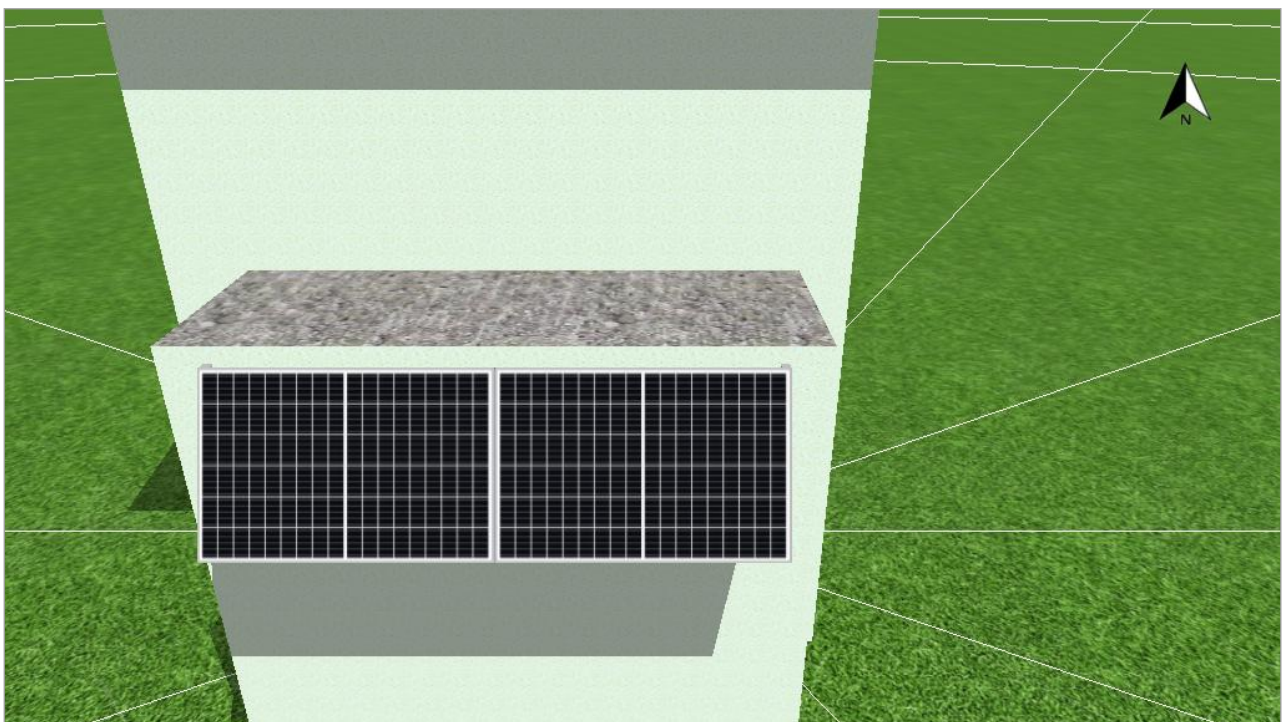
Modulfläche - Gebäude 02-Fassade Süd
